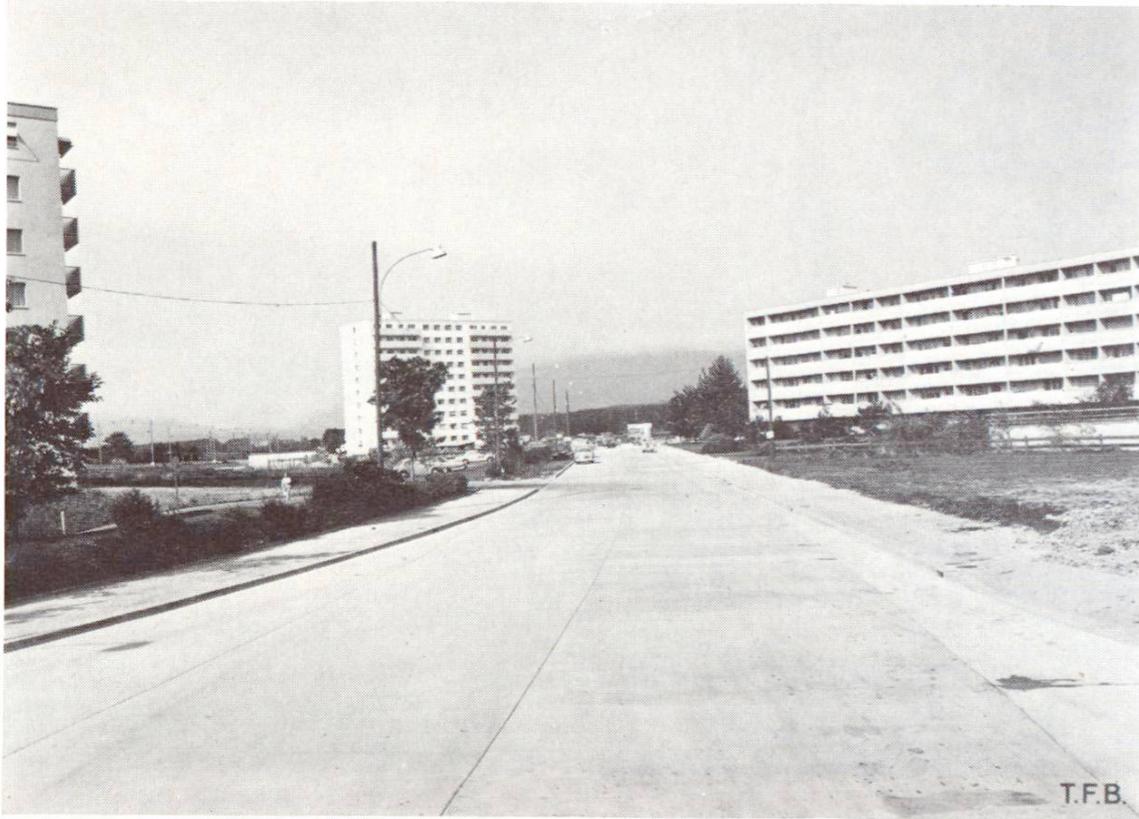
L'Avenue Pierre de Savoie à Yverdon, construite en 1967 a donné accès aux grands immeubles dès leur construction hors de ville. Elle se trouve sur un terrain tourbeux compressible dont on a artificiellement suscité le tassement avant la construction du revêtement.
